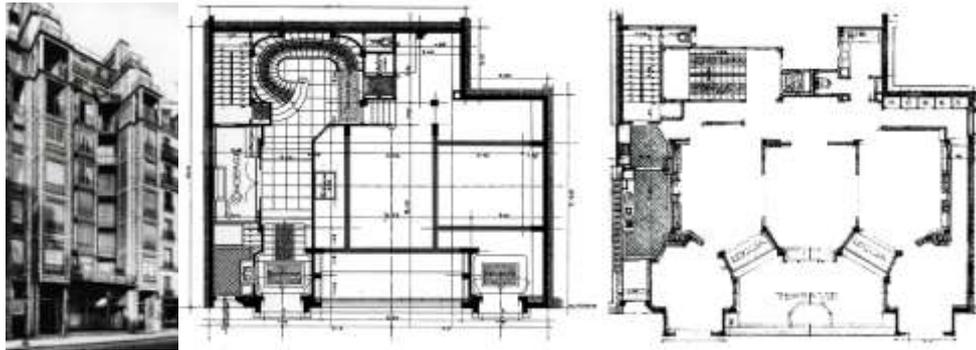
Edifício rua Franklin 29 em Paris: a) Fachada exterior (BRITTON, 2001); b) Planta do piso térreo (BRITTON, 2001); c) Planta tipo dos apartamentos (GARGIANI, 1993).
